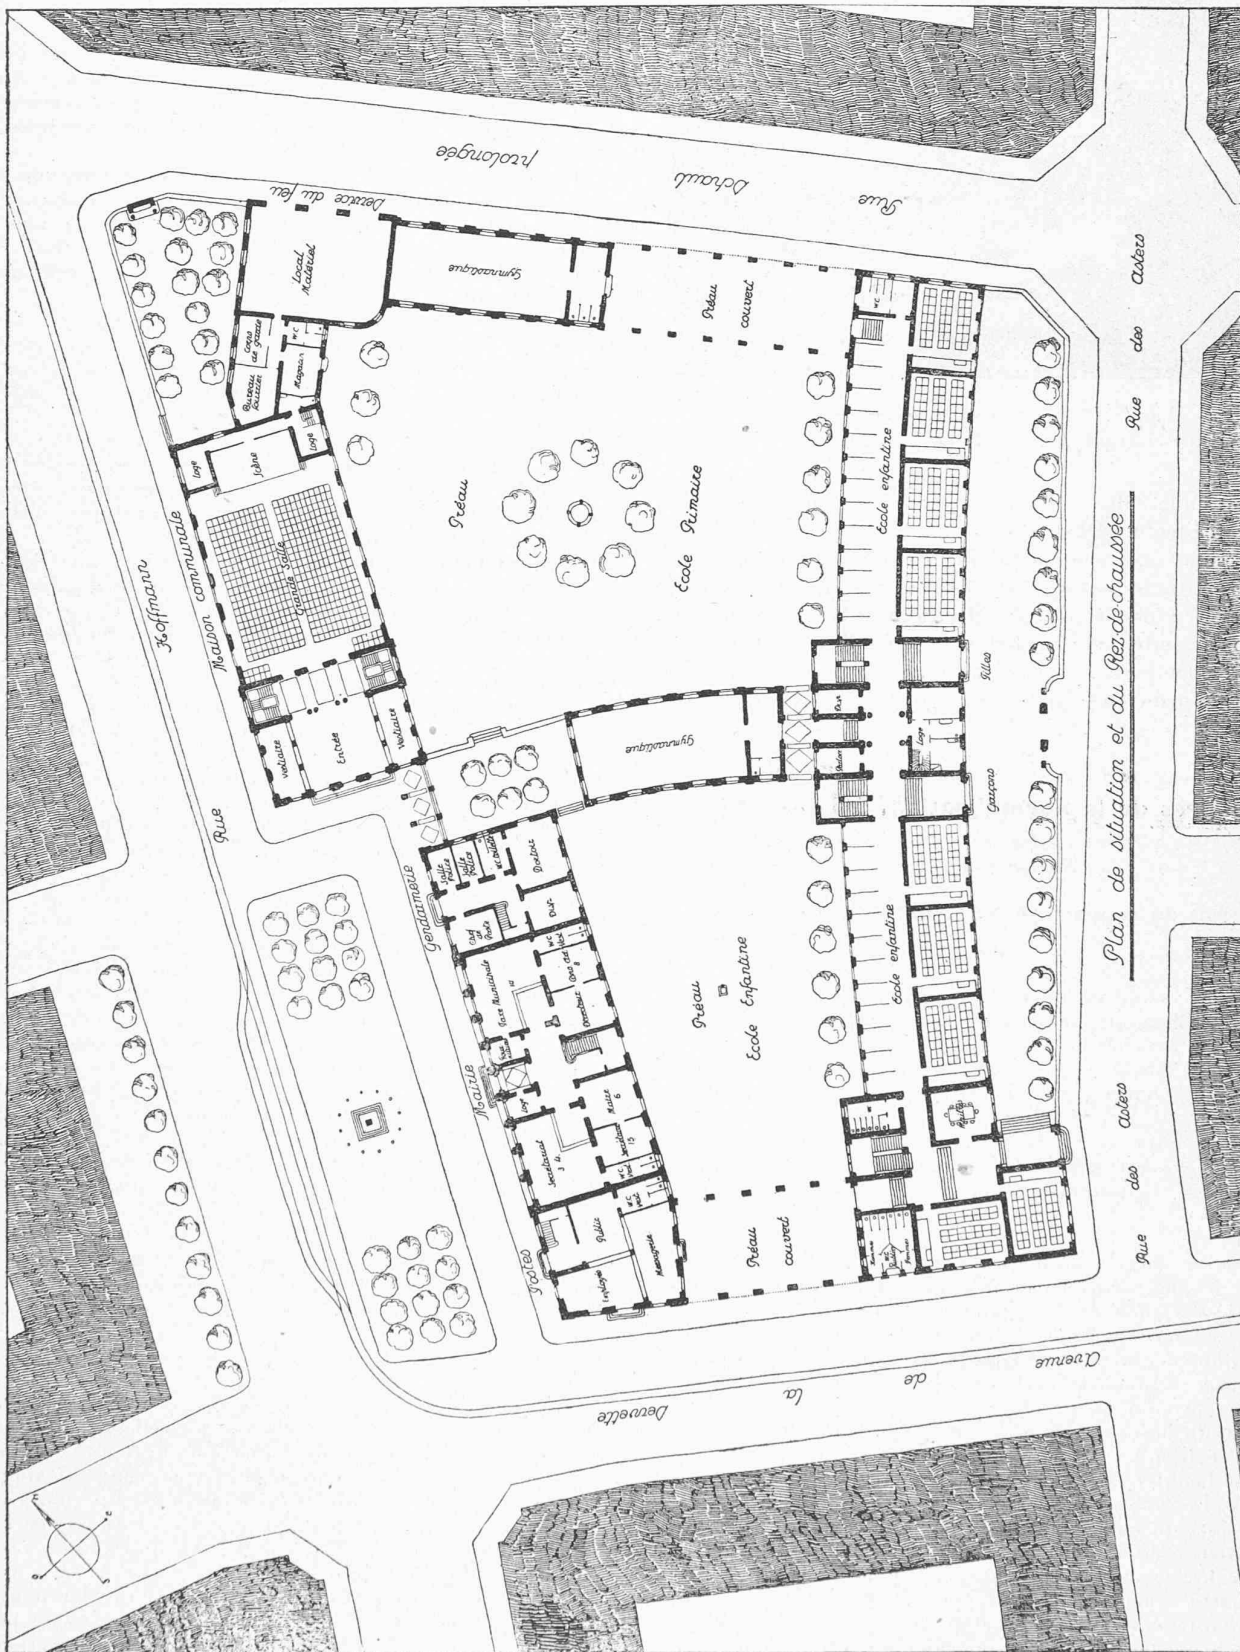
Plan général et rez-de-chaussée. — 1 : 800.
